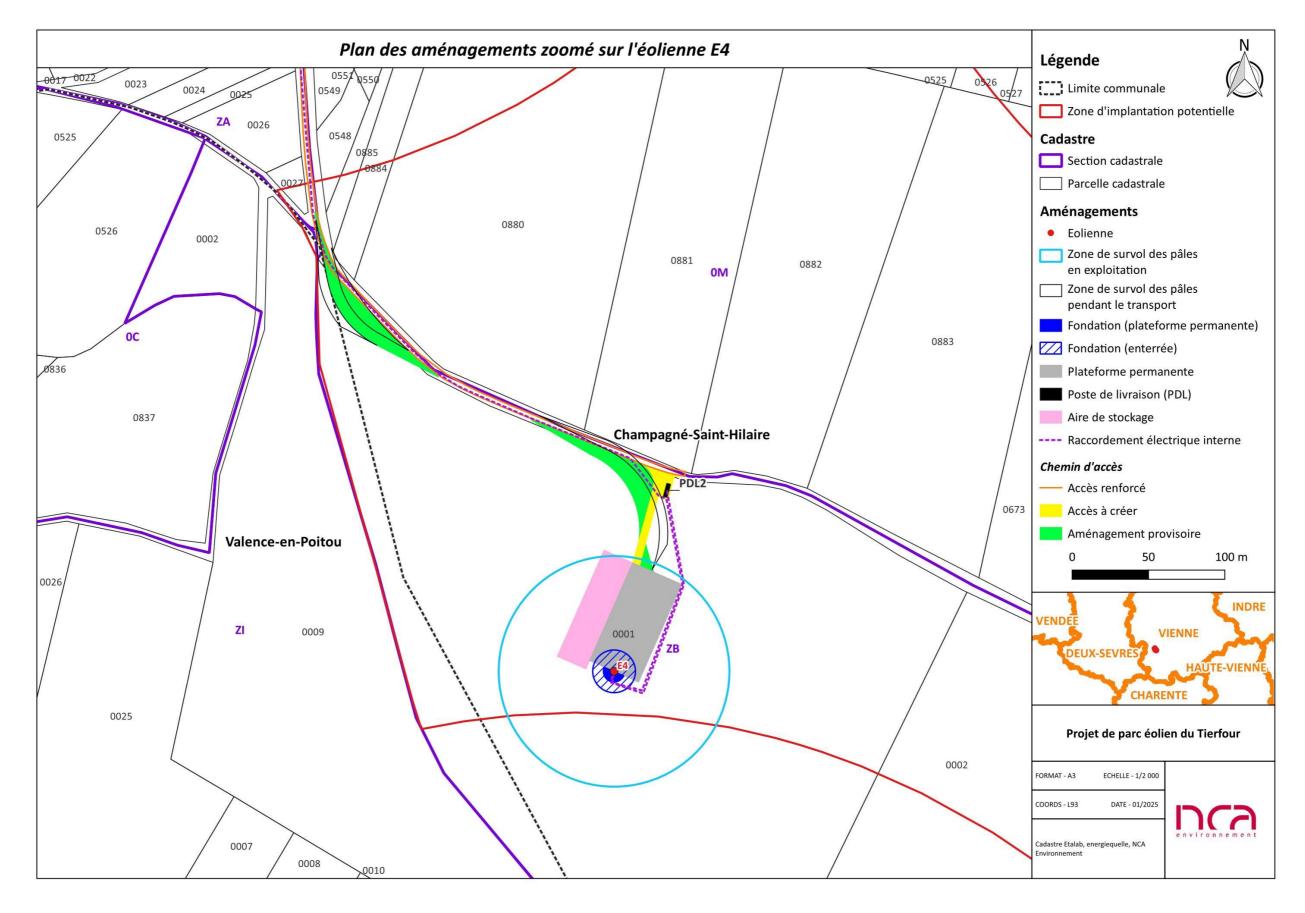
Plan des aménagements sur fond cadastral zoomé sur l'éolienne E4
